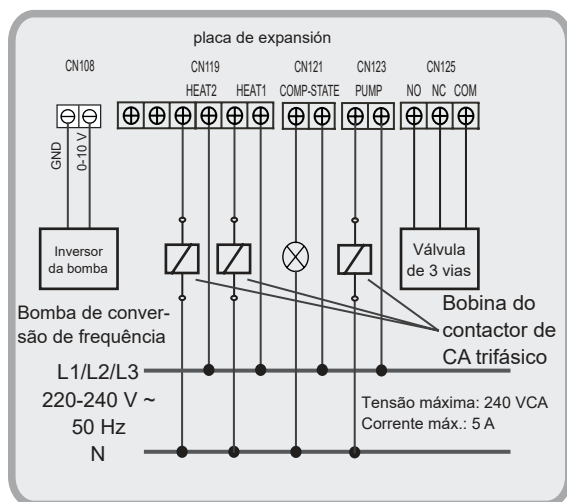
Cablagem do aquecedor auxiliar do tubo e da luz de estado da CA do compressor (50/60/70kW)
